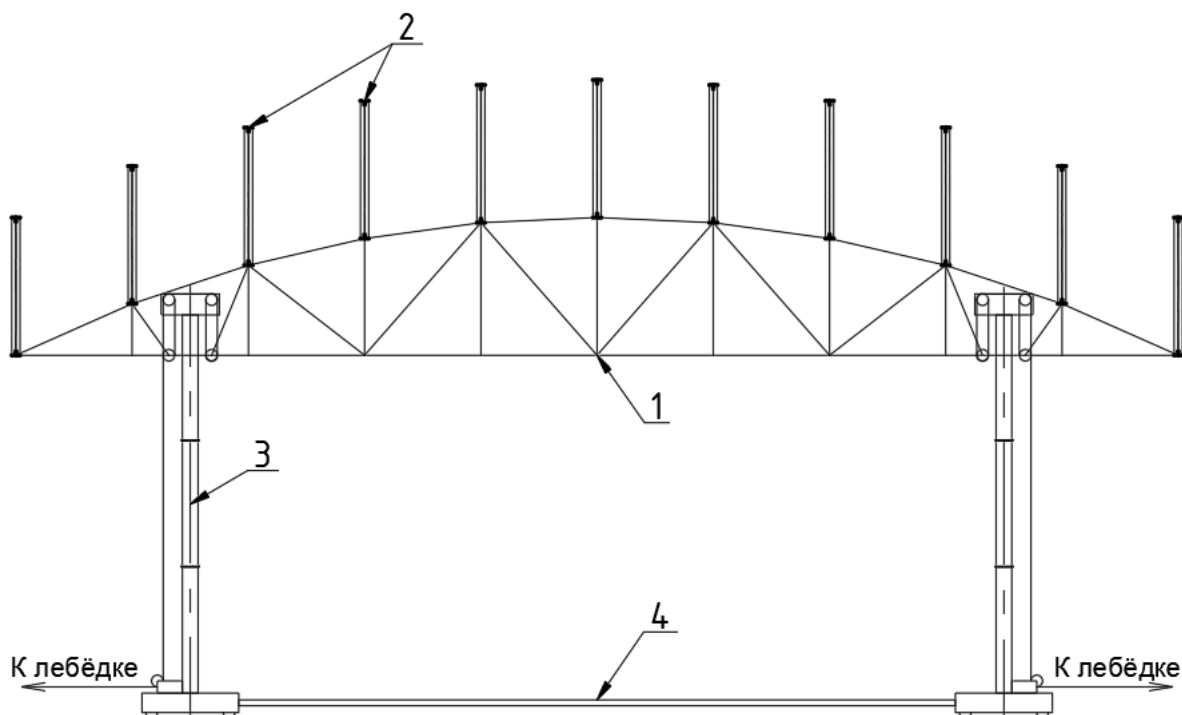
Передвижной кондуктор для монтажа железобетонных оболочек двойной положительной гауссовой кривизны: 1 – главные фермы; 2 – кружальные прогоны; 3 – стойки; 4 – жёсткие связи
